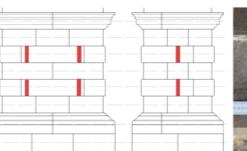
Front und Seitenansicht, rot markiert = Scheinfugen
